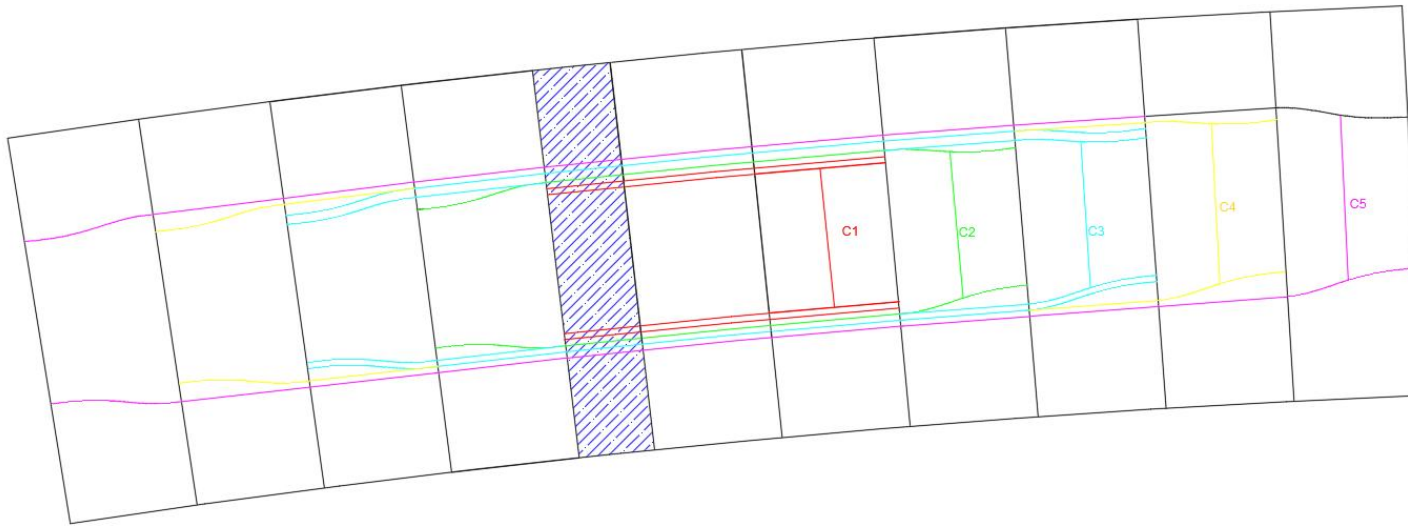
Tracé en plan de câbles de continuité de travée de rive
